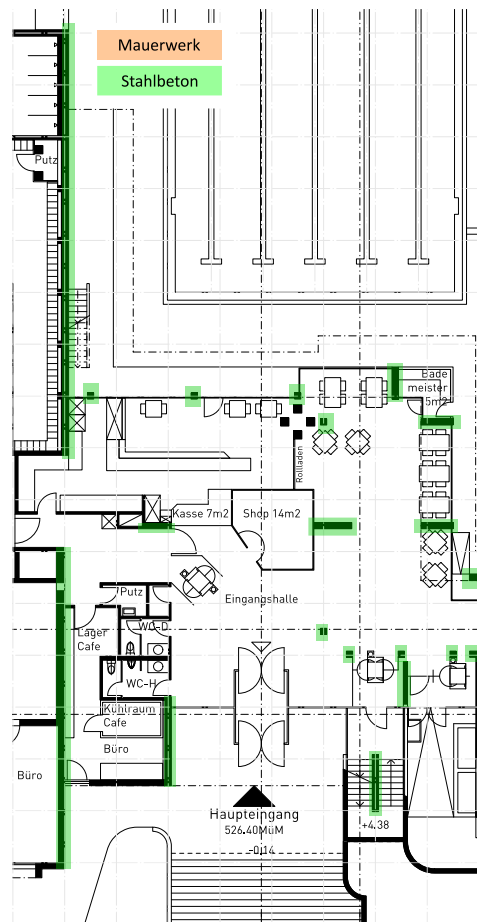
Modellierte Stützen und tragende Wände im Bereich der Eingangshalle (Erdgeschoss)
